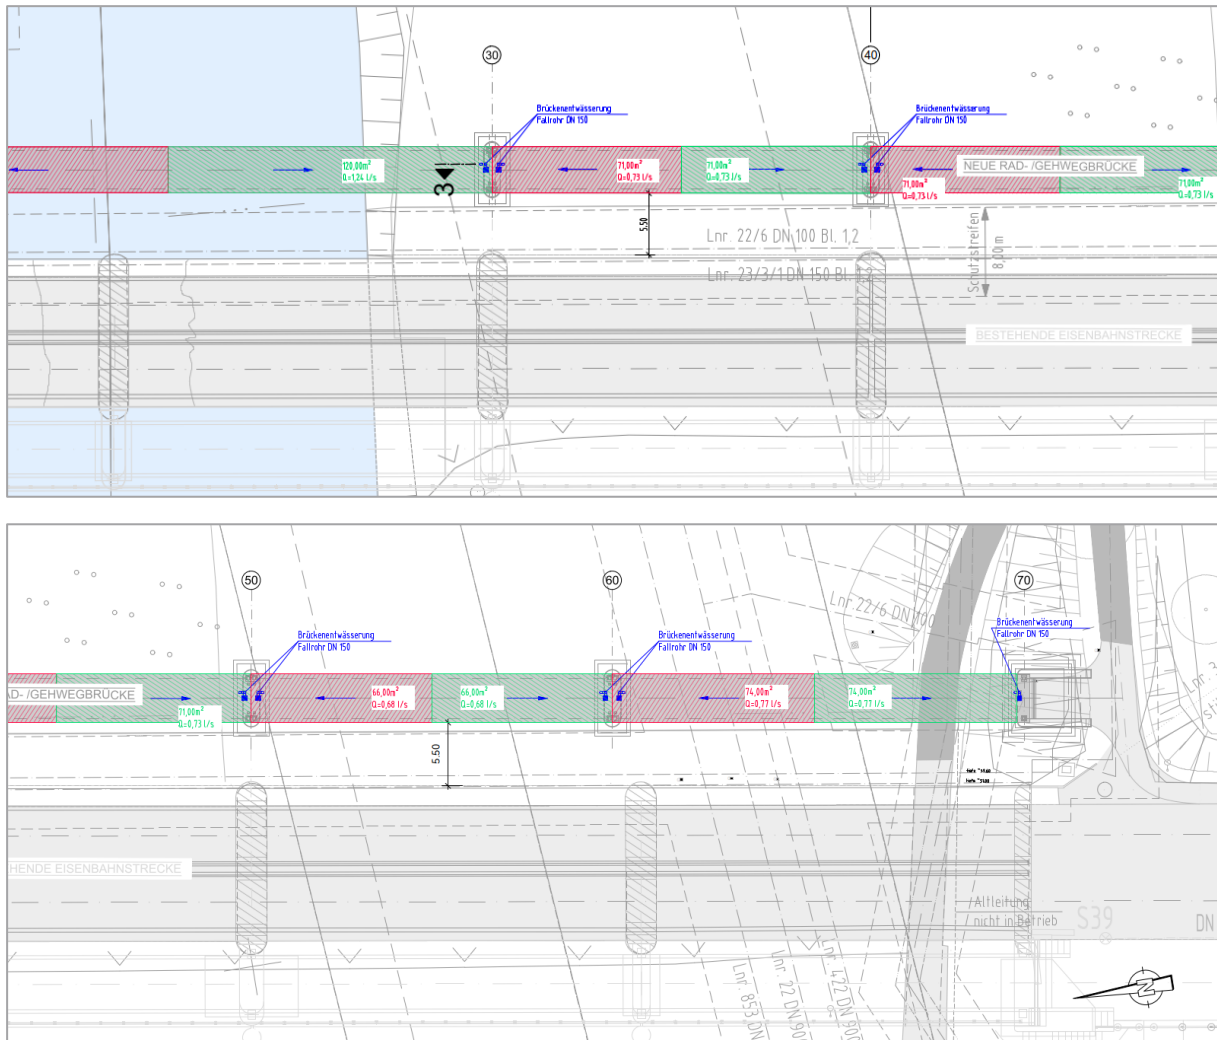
Entwässerung der Brücken in das Siegvorland (oben: Achse 30-40, unten: Achse 50-70), angepasst aus dem Genehmigungsplan zum Einleit Antrag: Entwässerung / Flächenplan Brücke und Rampe über die Sieg [7]
